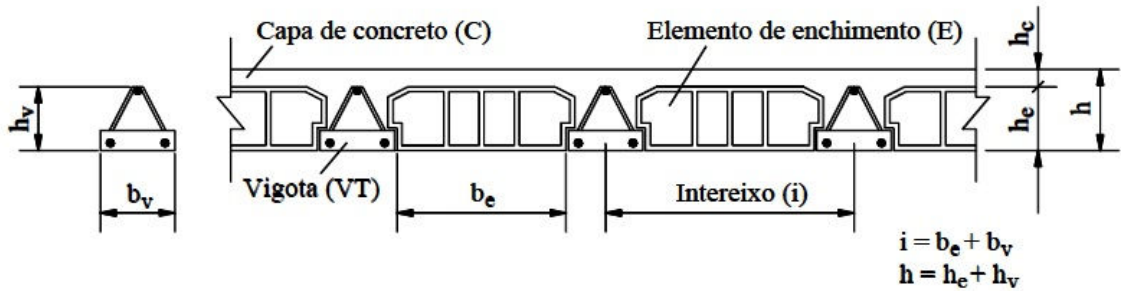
Seção transversal de uma laje com vigotas treliçadas
